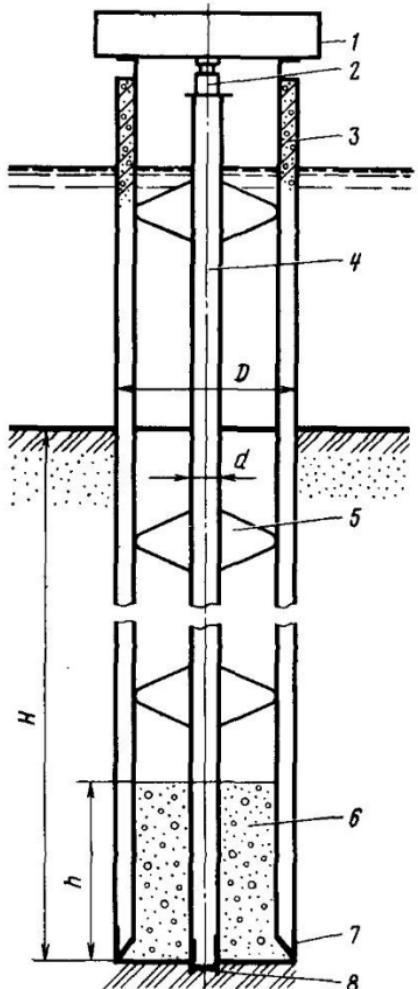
Установка для испытания штампом грунта в основании свай-оболочки:
